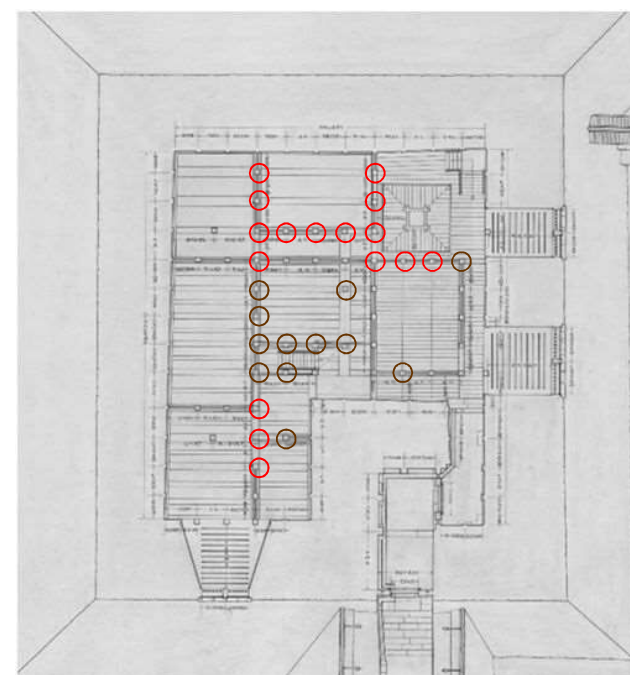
地階「名古屋城天守地階平面図」(部分)
